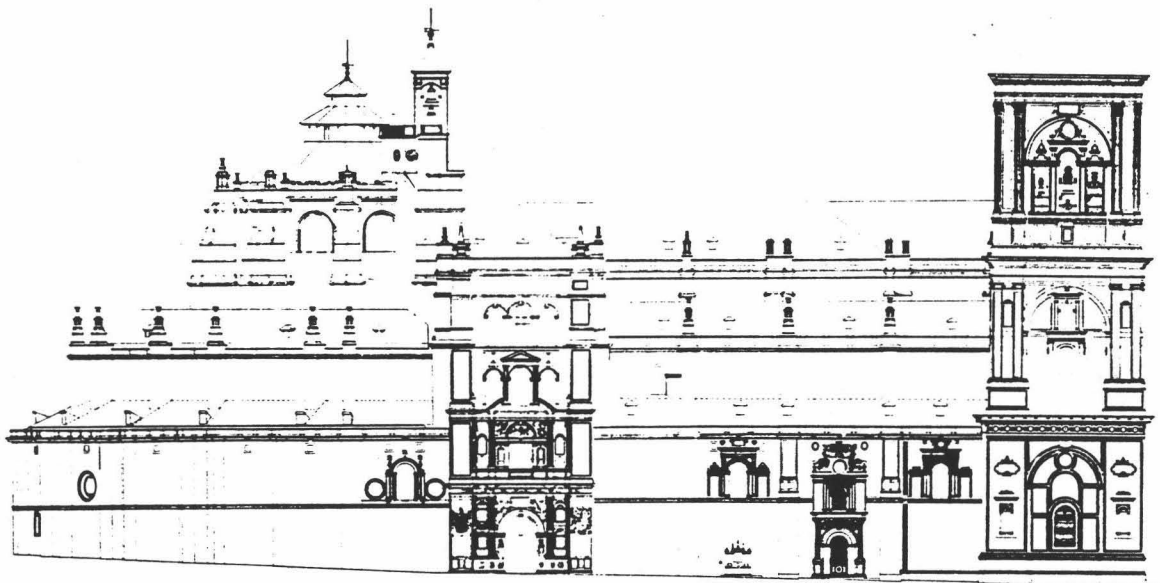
Fachada a c/ Cárcel Baja. Destacan las Portadas del Perdón y de San Jerónimo. Escala 1:1000
